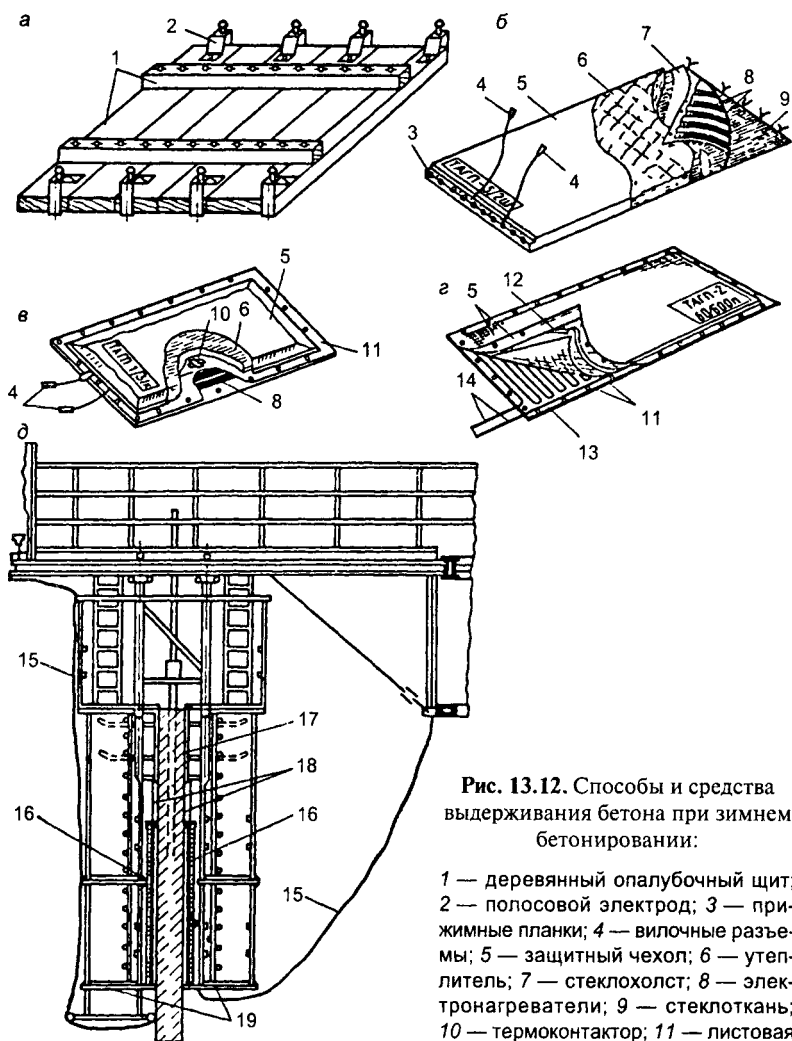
Способы и средства выдерживания бетона при зимнем бетонировании:
